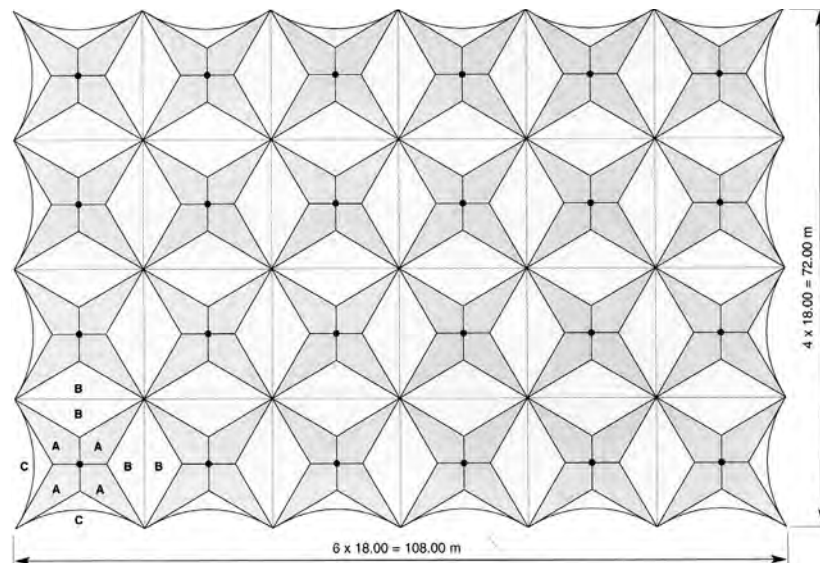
Grundriss der 24 Tulpen aus faserverstärktem Kunststoff
